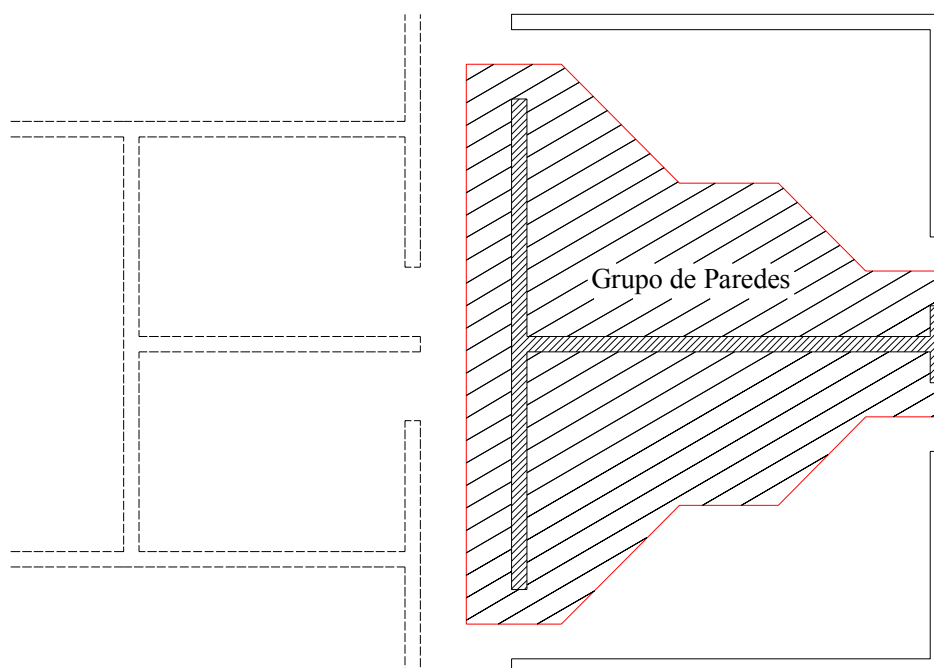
Transferência de cargas verticais para grupo de paredes. Adaptado de HENDRY (1981)
